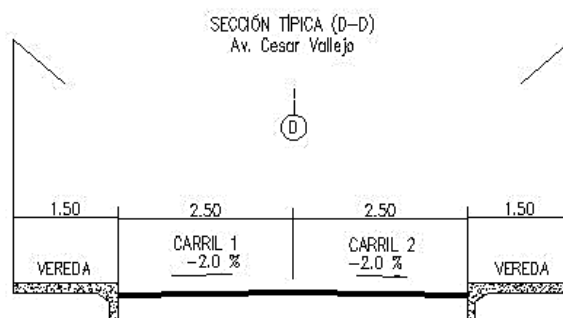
Sección Transversal de la Calle Cesar Vallejo corte D-D
